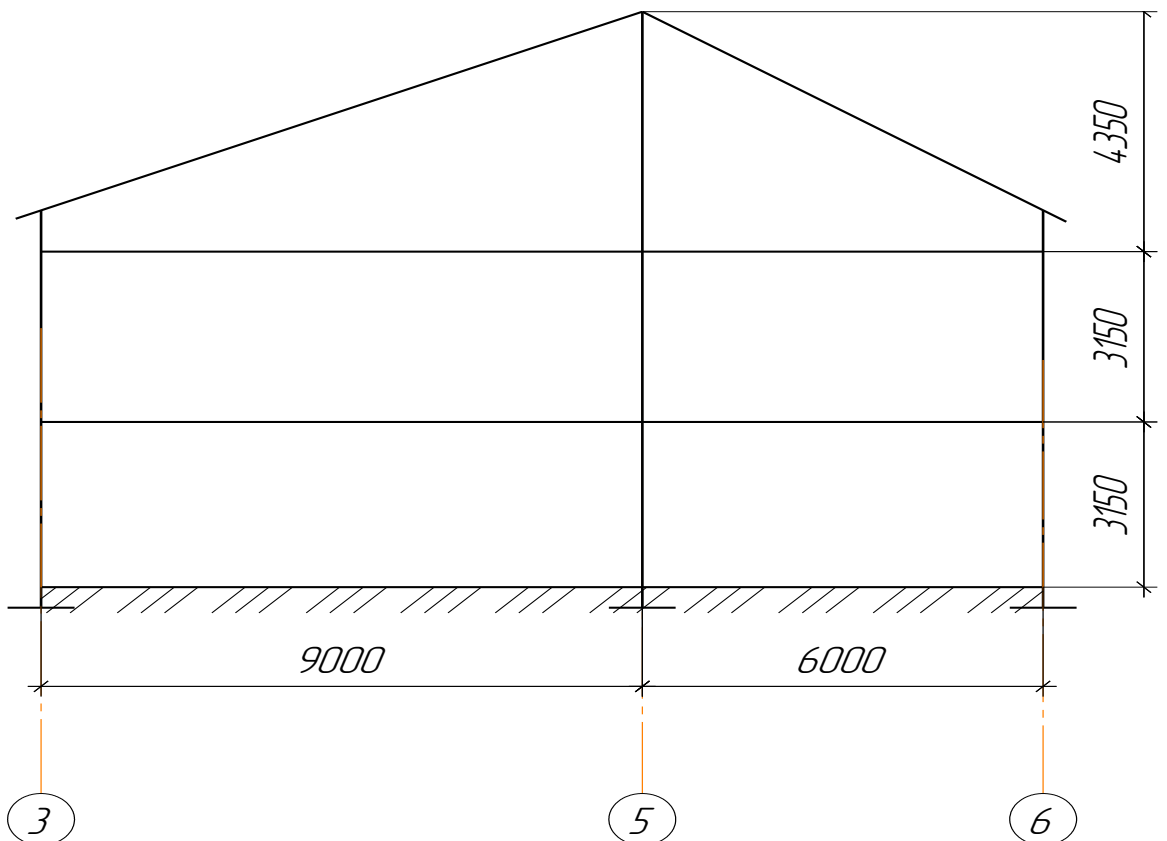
Схема поперечного разреза здания в осях 3-5
